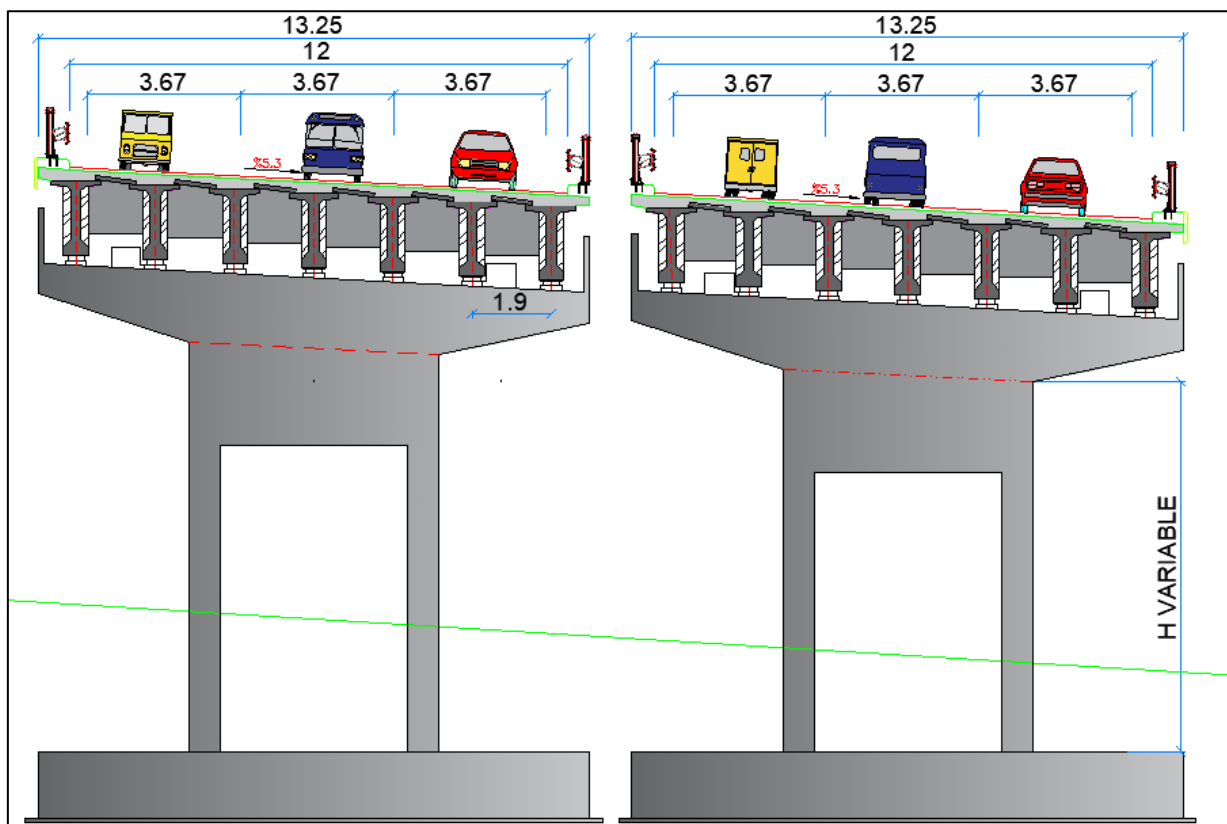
Coupe transversale sur pile VARIANTE 01
